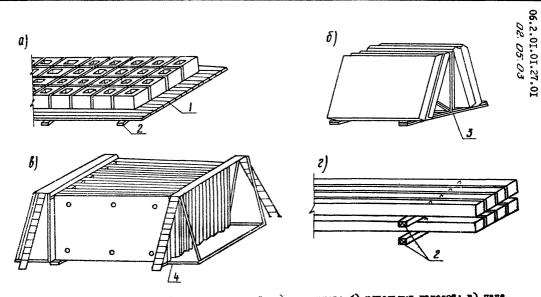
Складирование сформых конструкций: в) оголовков; б) цекольных нанедей; в) панедей перекрытий; г) ростверков и балок. 1-настил из досок 40ми; 2-подидадка 80х80ми; 3-металдическая пирвыя да на 4 цокольные панеди; 4-кассета конструкции Гипрооргесльстроя
